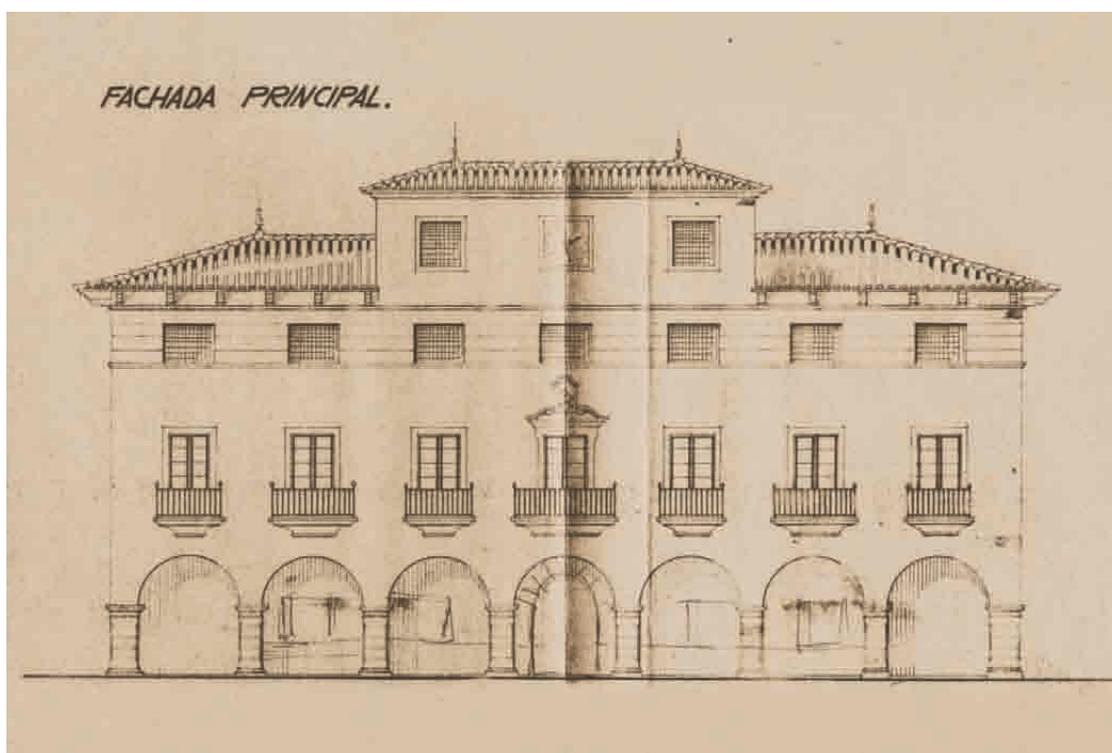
Alzado de la fachada proyectada por Enrique Juncosa para el Ayuntamiento de Calvià.
